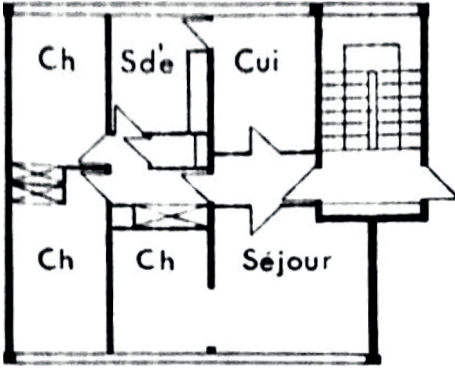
Plan d'un logement à Bondy, la Noue Caillet, 1960
